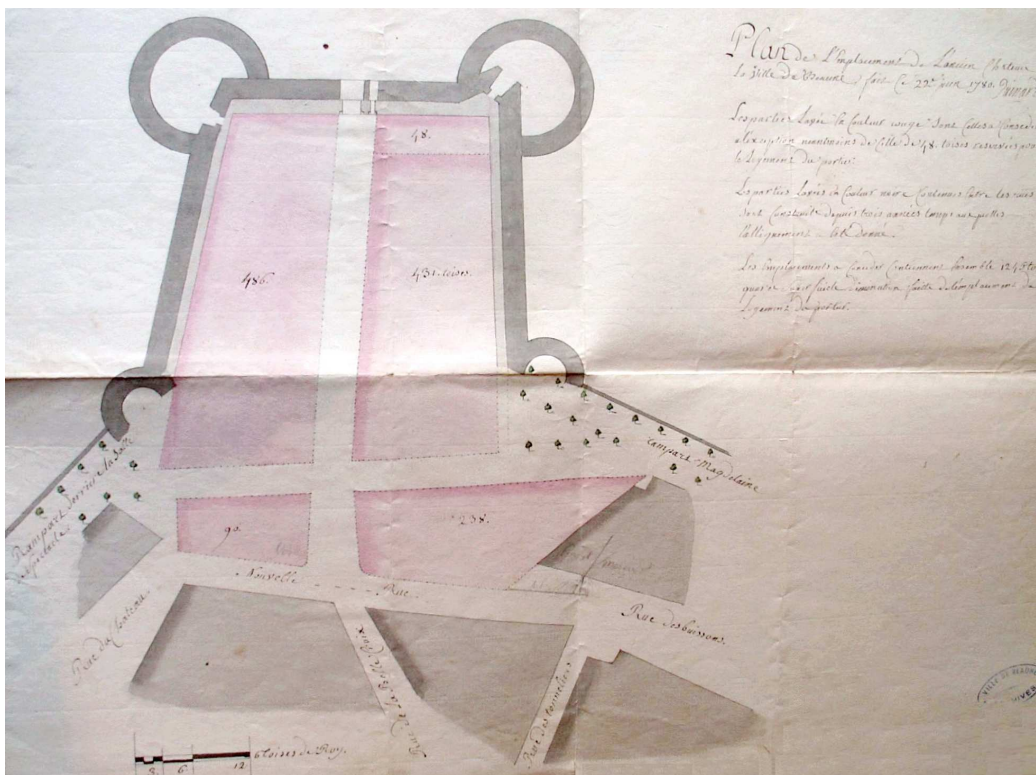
Plan des rues projetées dans le château de Beaune par Quinard, 22 juin 1780 (AMB, car. 93, cote 46). Texte en haut à droite :
